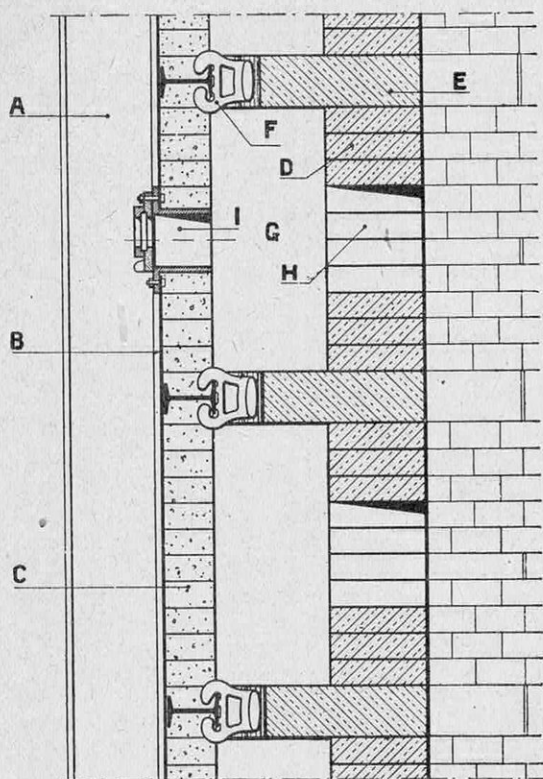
DÉTAIL DE CONSTRUCTION DU MUR CREUX
